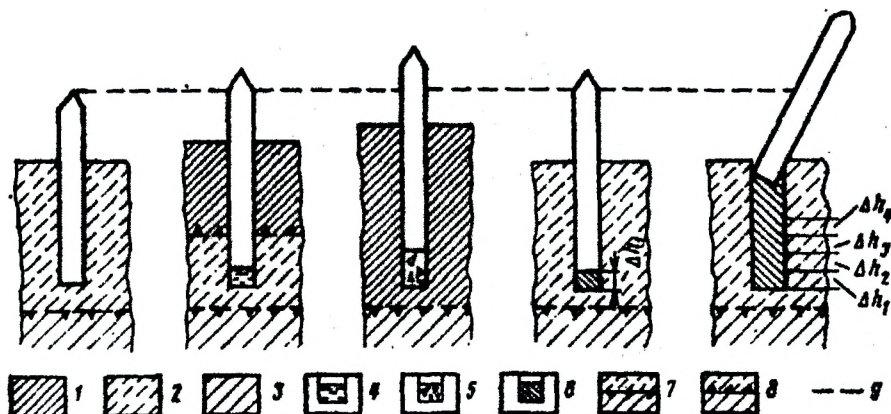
Схемы выпучивания столба из сезонно-промерзающего грунта в зоне вечной мерзлоты: 1 – мерзлый грунт; 2 – талый грунт деятельного слоя; 3 – вечномерзлый грунт; 4 – вода или разжиженный грунт; 5 – лед или сильнольдистый грунт; 6 – талый грунт в полости под столбом; 7 – верхняя граница вечномерзлого грунта; 8 – граница промерзшей части деятельного слоя; 9 – первоначальный уровень верха столба
